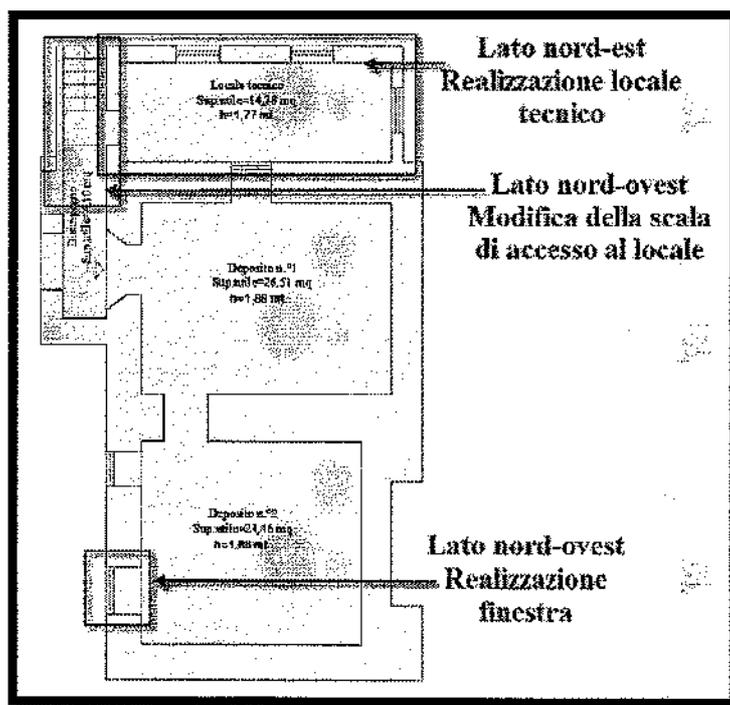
Pianta piano seminterrato (sub 4) – Rilievo eseguito in occasione dei sopralluoghi
